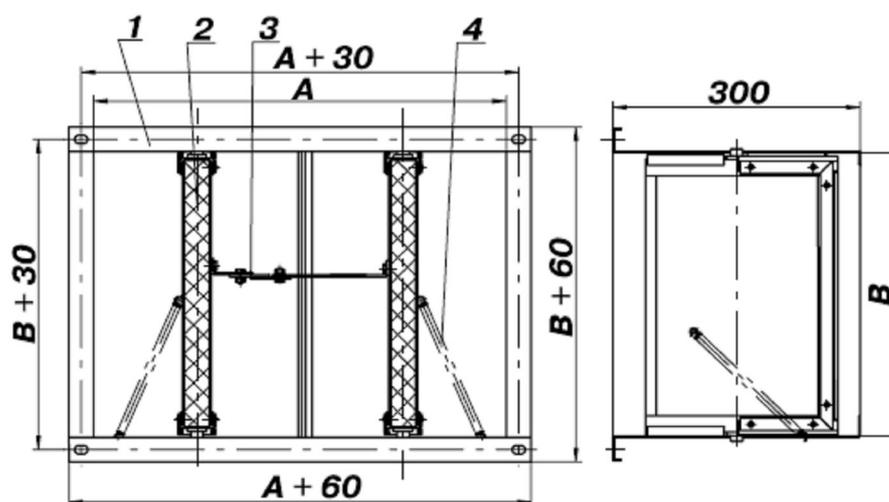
Прямоугольный клапан стенового исполнения с плавким предохранителем и возвратной пружиной: 1 – корпус; 2 – лопатка; 3 – плавкий предохранитель; 4 – пружина
